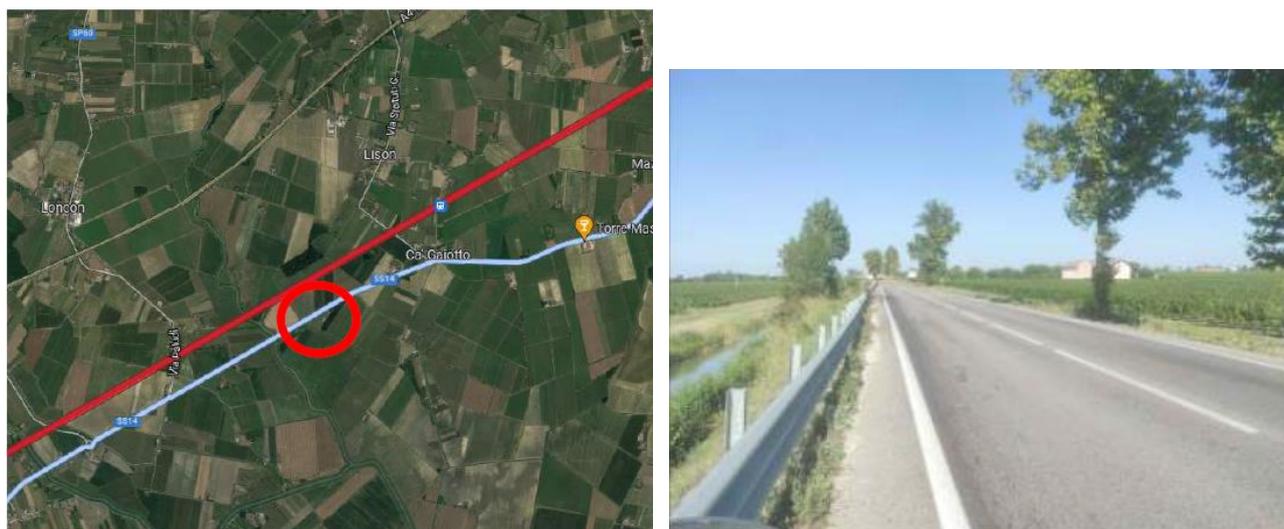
e 7 – Localizzazione di dettaglio dell'area dell'intervento al km 53+500 Km e ripresa fotografica dello stato attuale della sede stradale (Fonte: Lista di Controllo)
